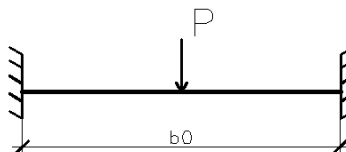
Расчетная схема для расчета на монтажную нагрузку
